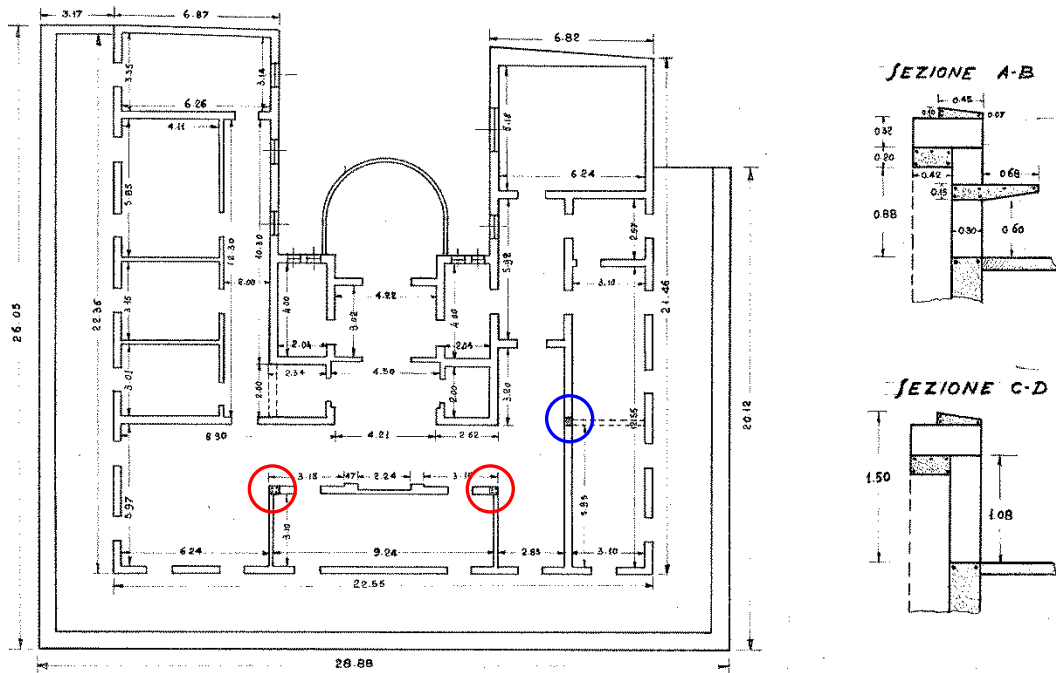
Pianta architettonica del piano 4° (da progetto esecutivo del 1937), con indicazione dei pilastri in c.a. Le tavole del progetto preliminare evidenziano inoltre la presenza di alcune travi in c.a., che collegano i pilastri interni ai vari piani, garantendo così l'appoggio al solaio (Figure 5.20-5.24).
